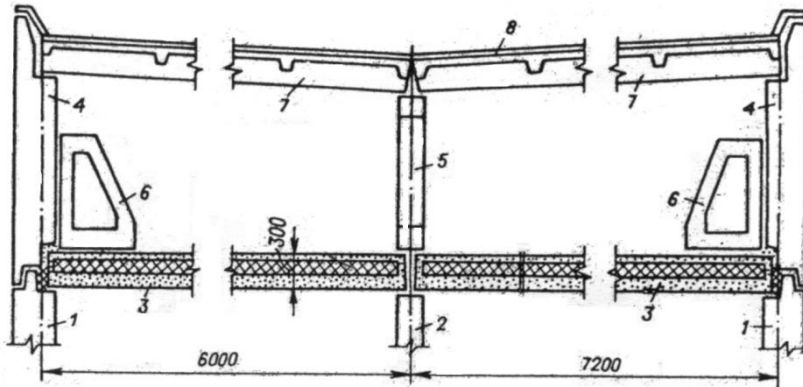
Разрез крыши с комплексными плитами чердачного перекрытия:
